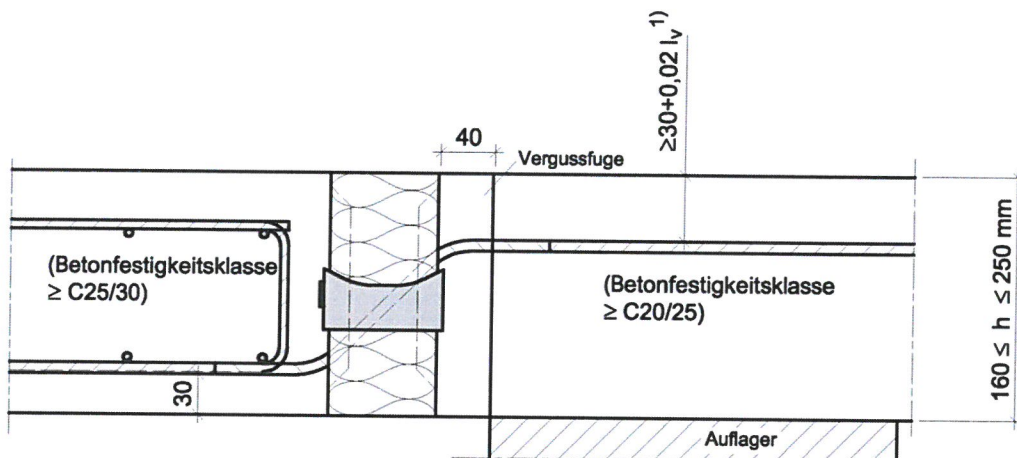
Schöck Isokorb Typ RQ-240 in eingebautem Zustand mit Vergussfuge
